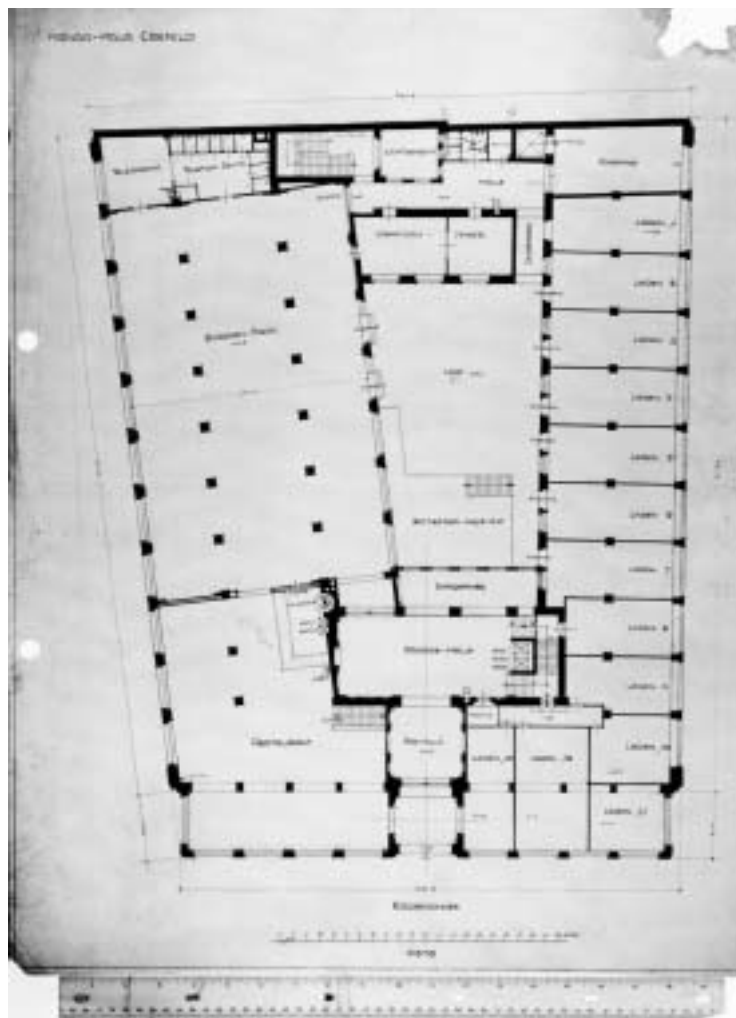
Grundriss Erdgeschoss, Entwurf von C. Moritz
